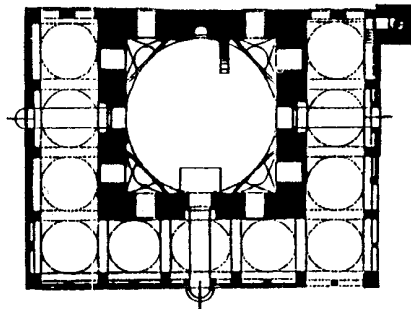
مسقط أفقى لمشهد يحيى الشبهي
